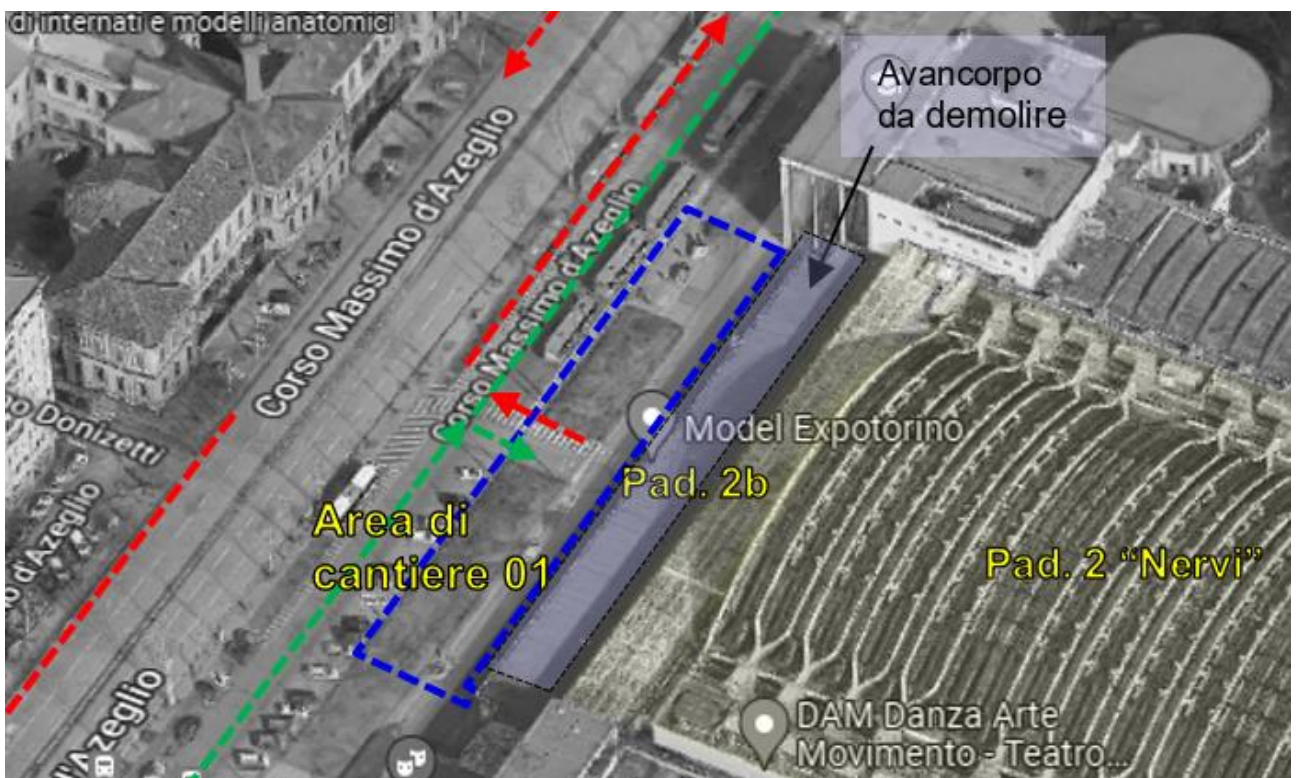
Dettaglio area di cantiere 01, lato C.so Massimo d'Azeglio
